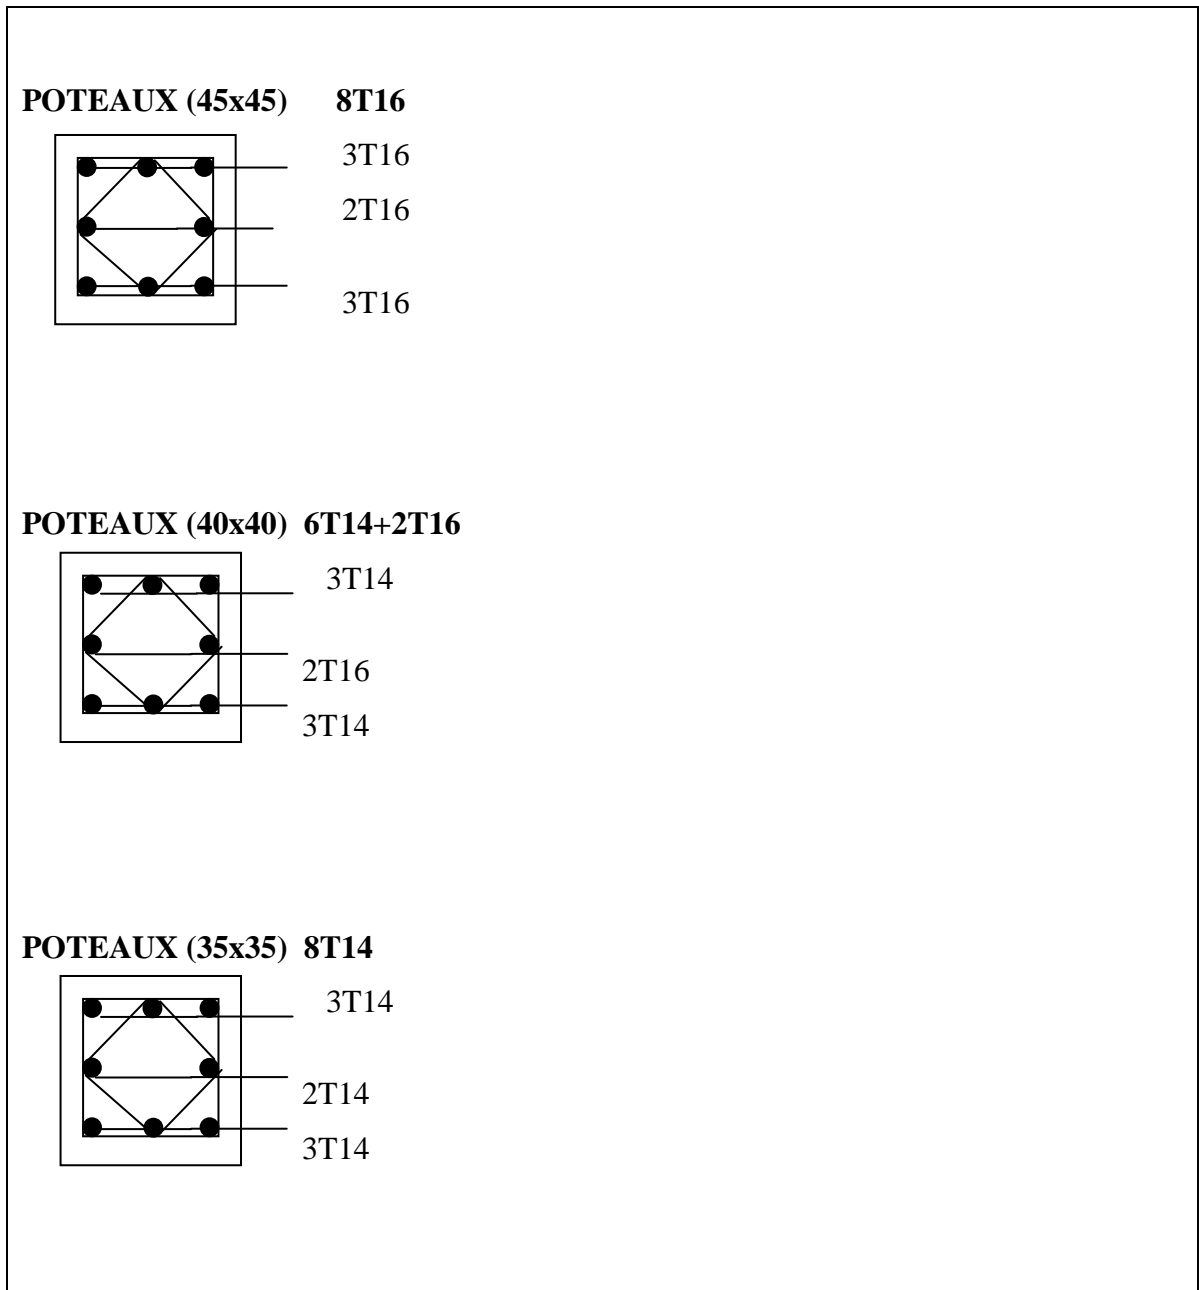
Dessin de ferrailages des sections des poteaux
